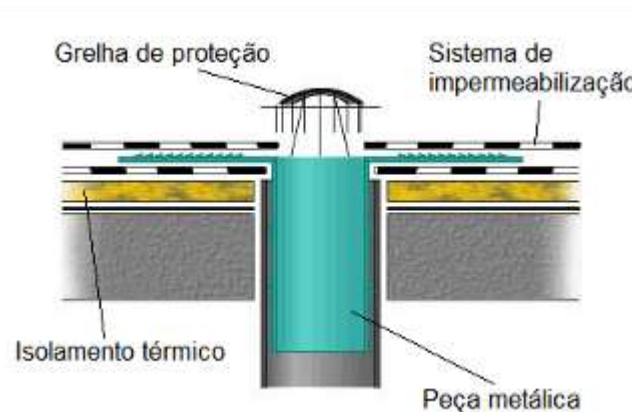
Pormenorização de um tubo de queda (adaptado de Imperialum, 2014)
